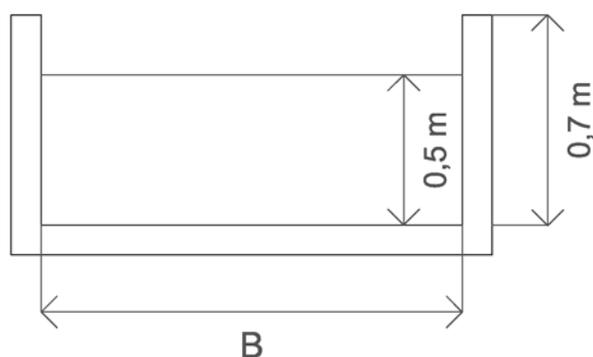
Planta y elevación de canal de salida y sus principales dimensiones.
